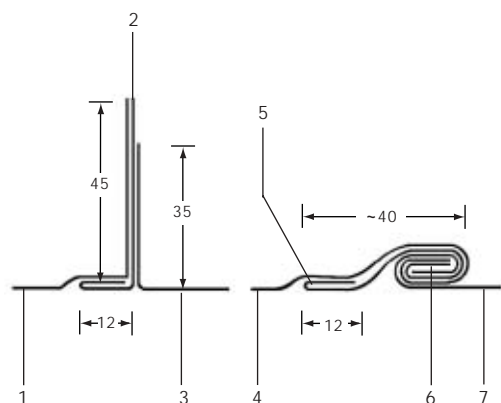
Detalhe em corte e planta do encaixe plano de dupla dobradura - plaqueta e lâminas / bandejas de cobre.
